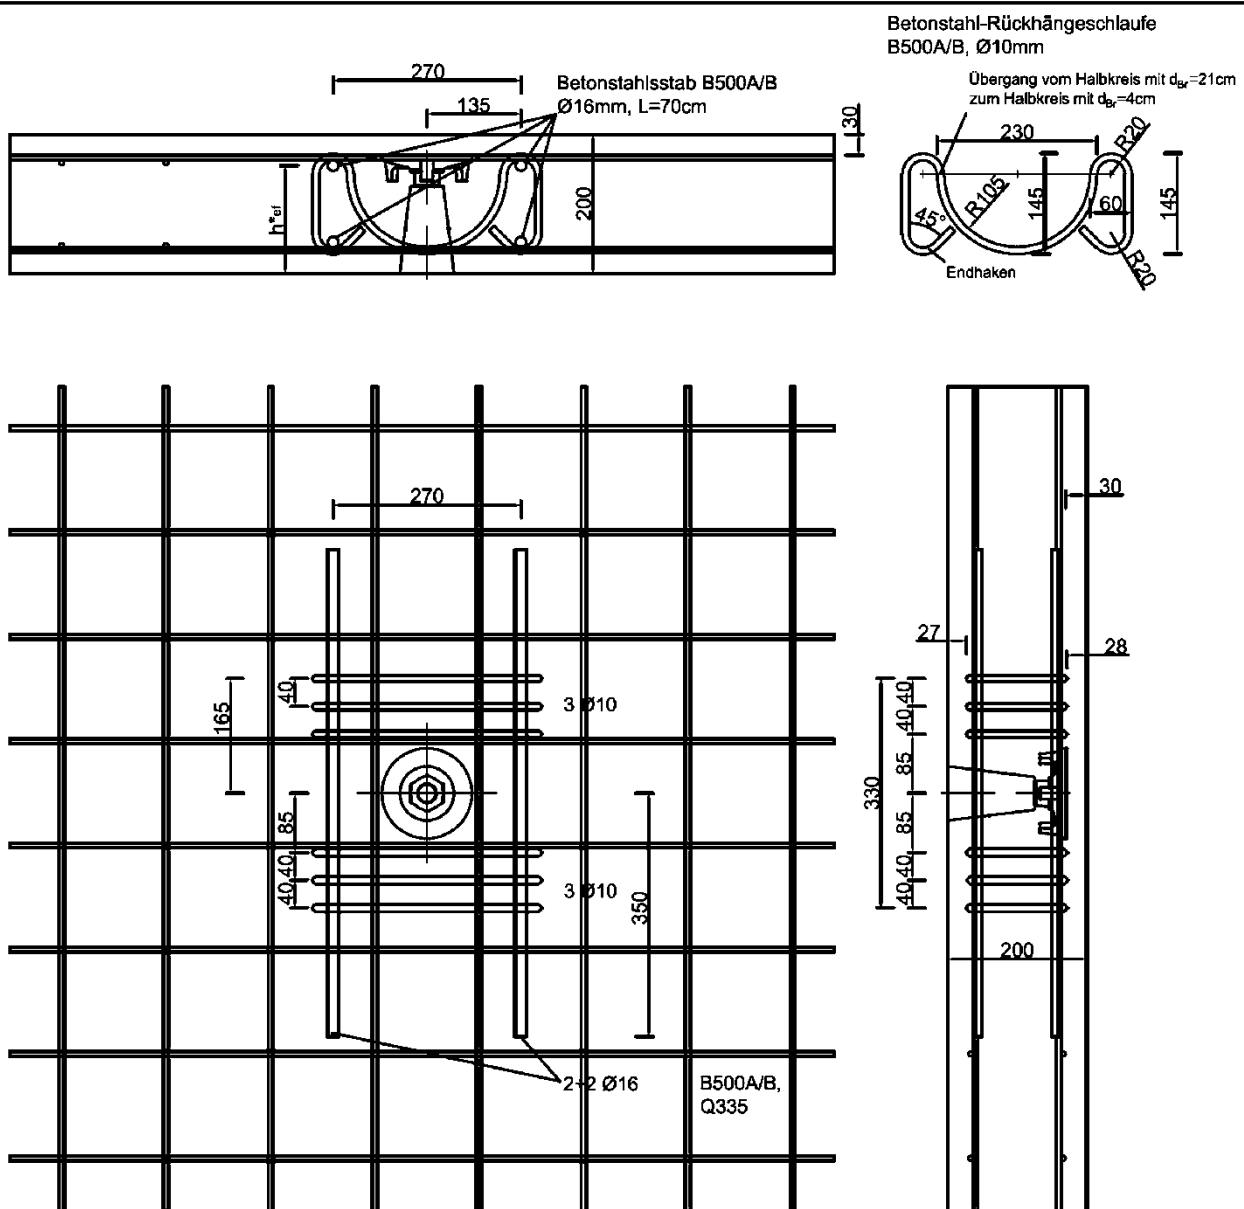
Darstellung des Bewehrungsmoduls im eingebauten Zustand für Wanddicke 200 mm (Abmessungen in mm)
